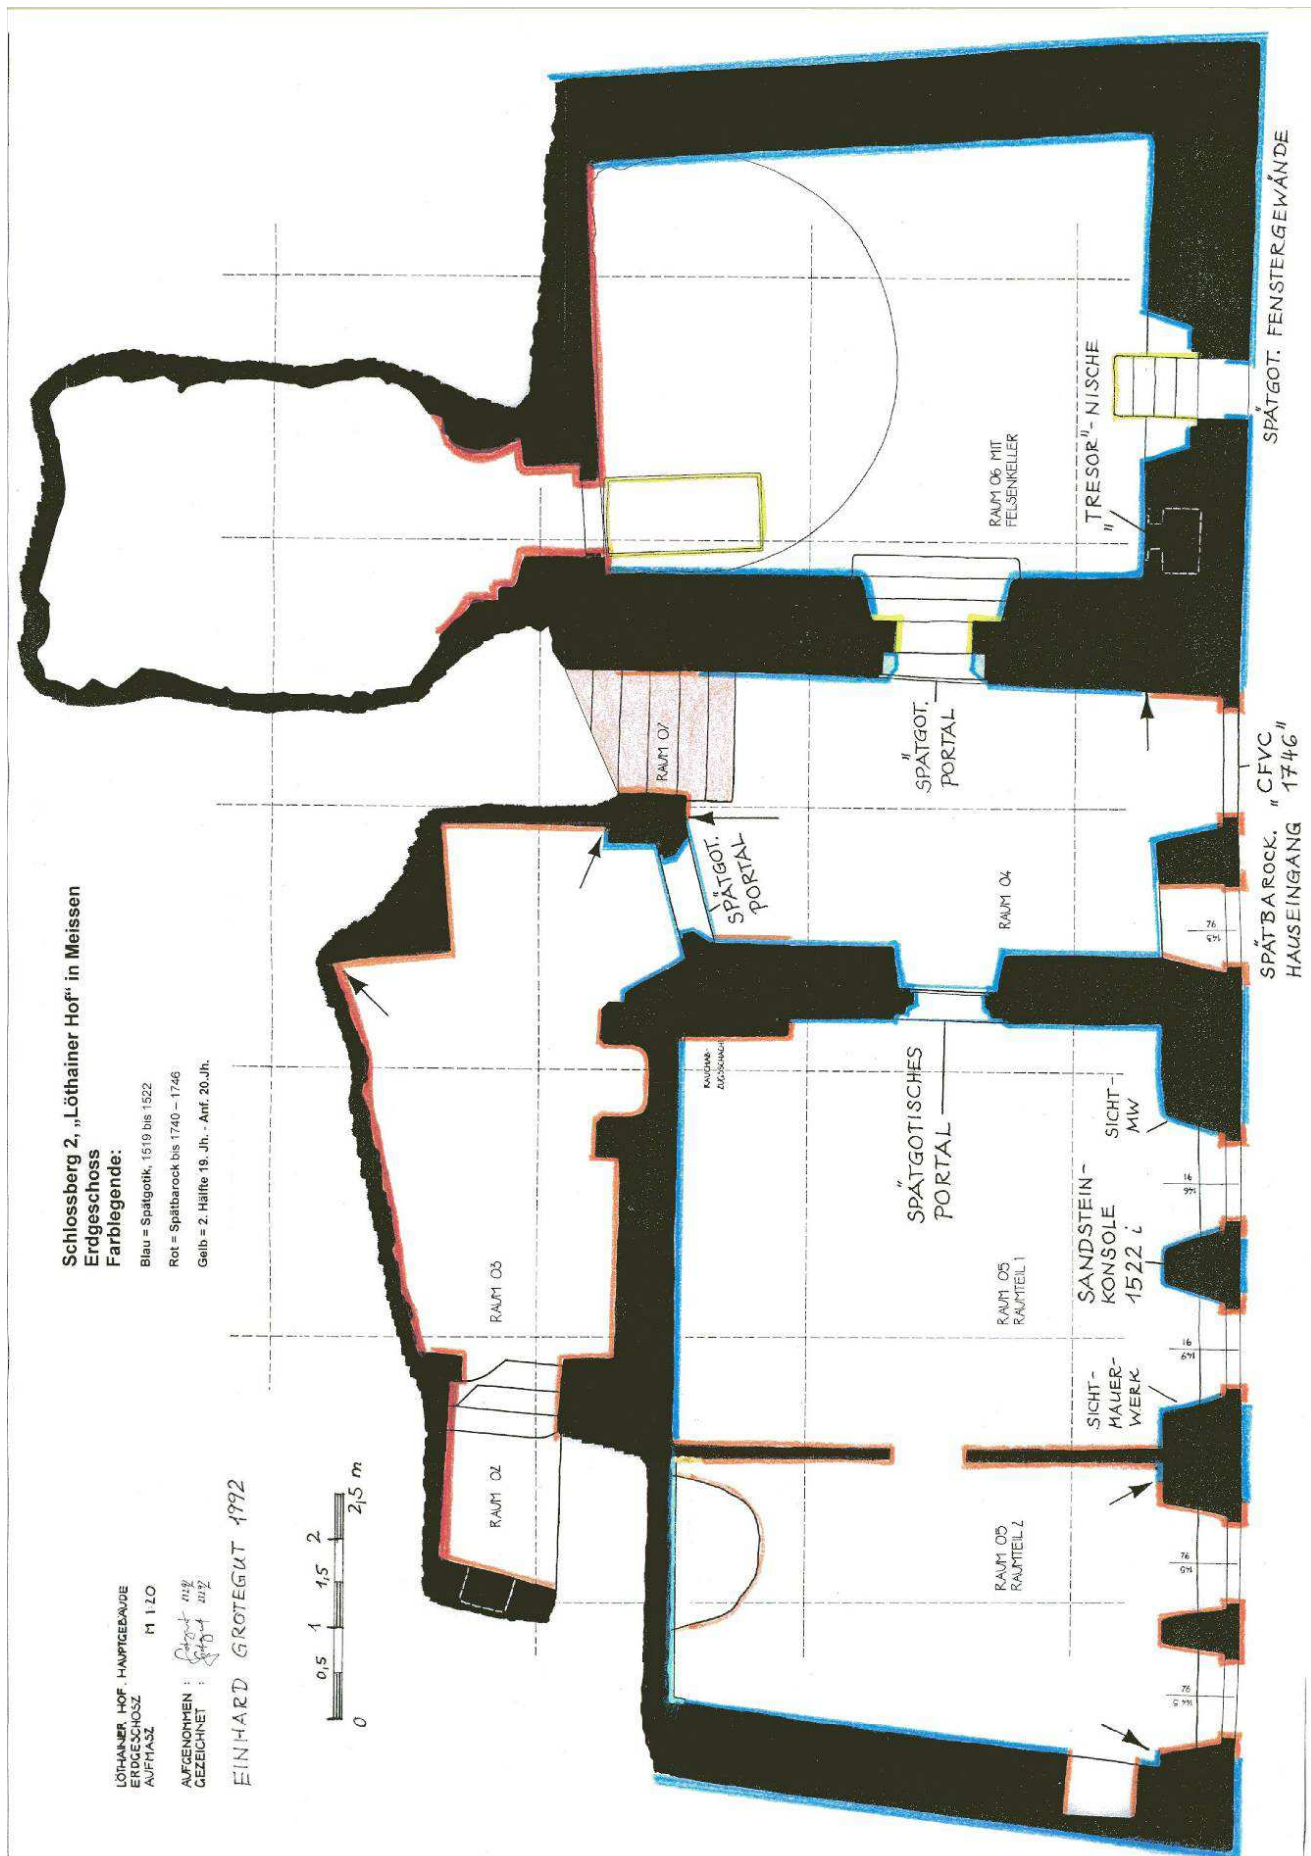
Schlossberg 2, Baualtersplan Erdgeschoss
